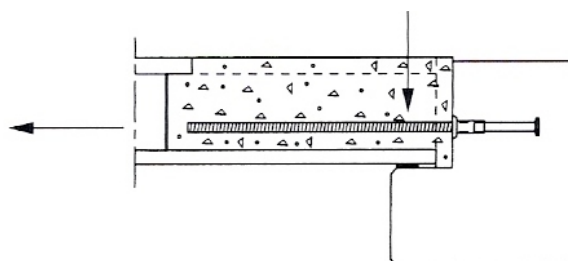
Ligação Laje - Viga (extraída de [10])
